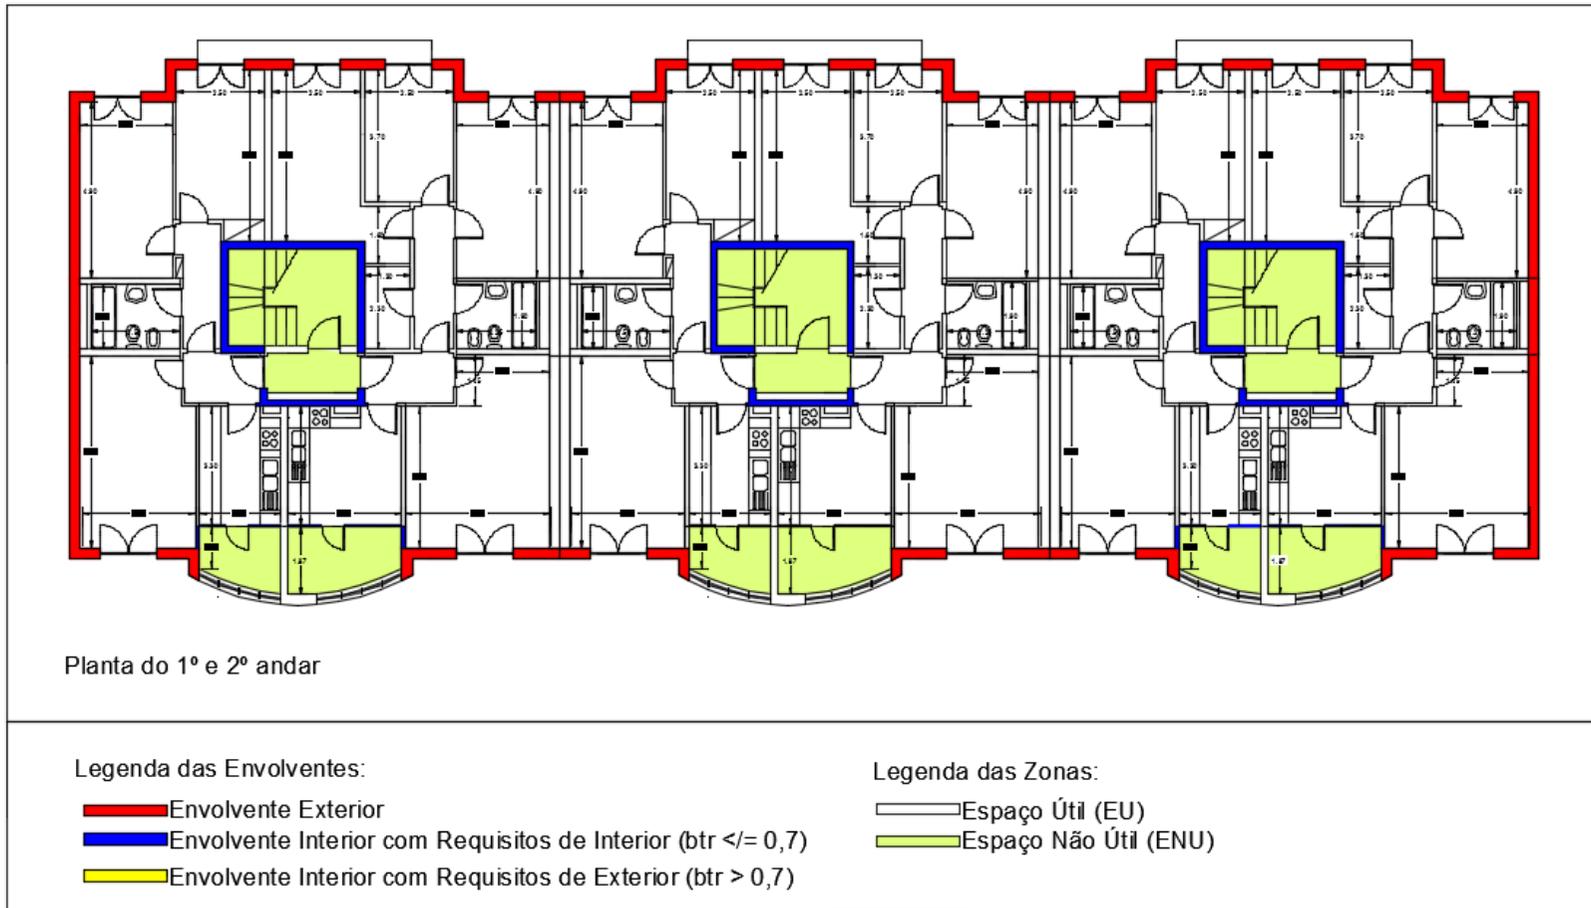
Definição da envolvente – Planta do 1º e 2º andar
